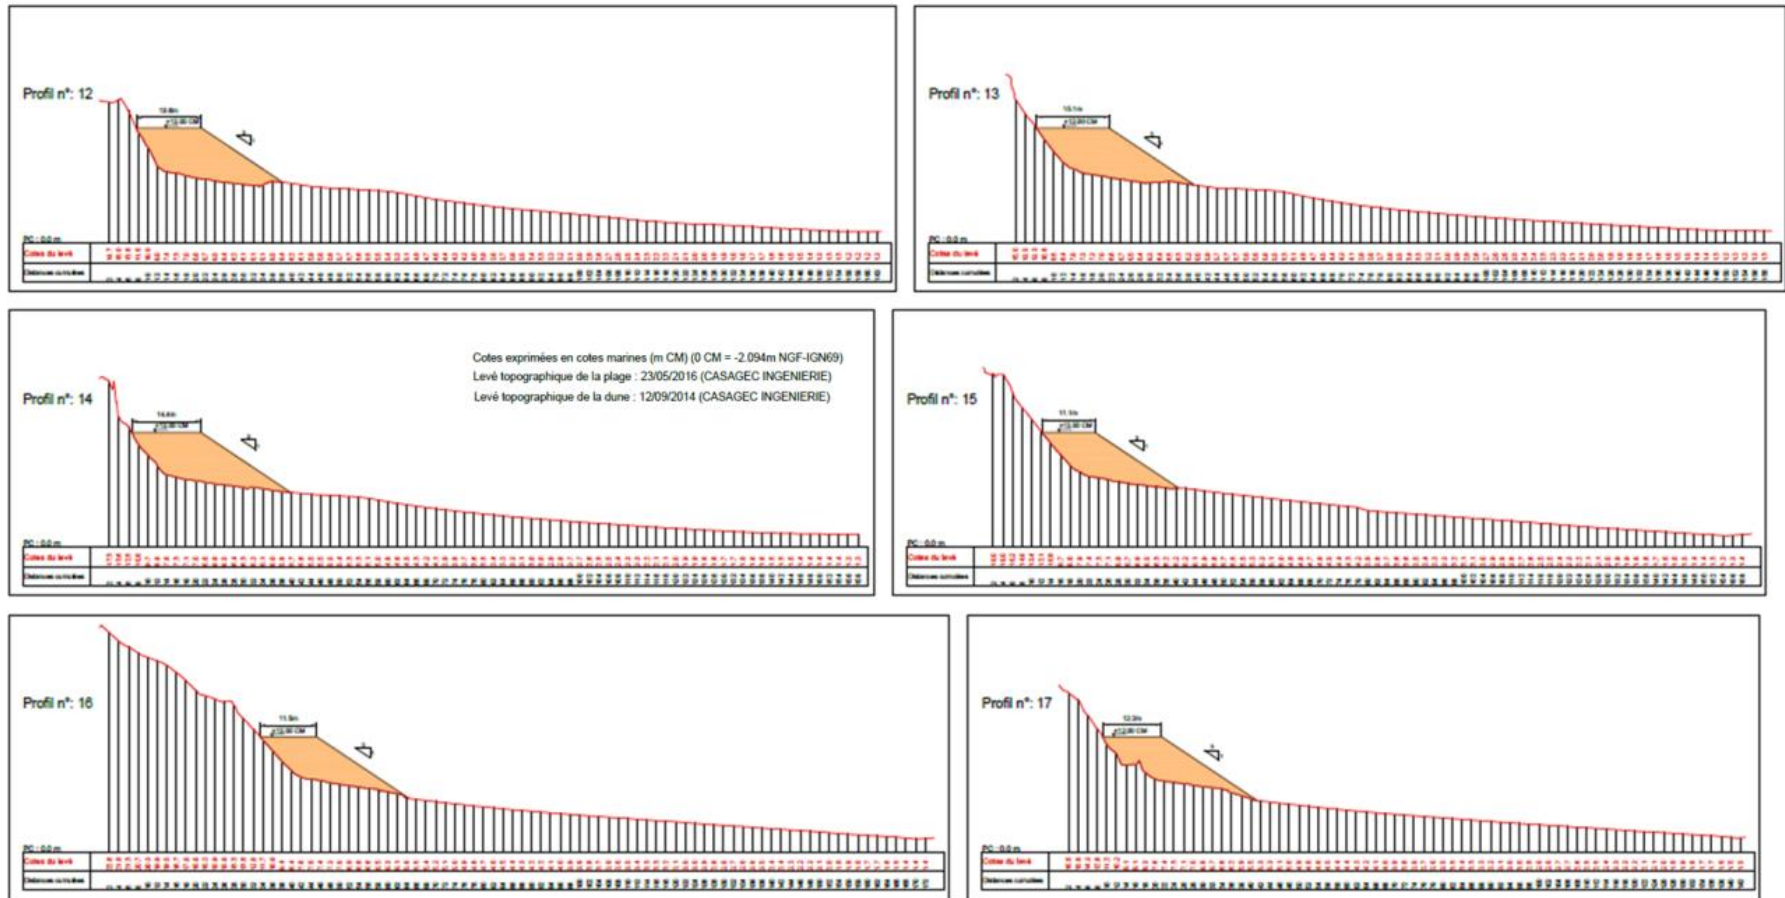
Profils type des rechargements des plages Sud (page de la Savane à la piste) 2/2.
